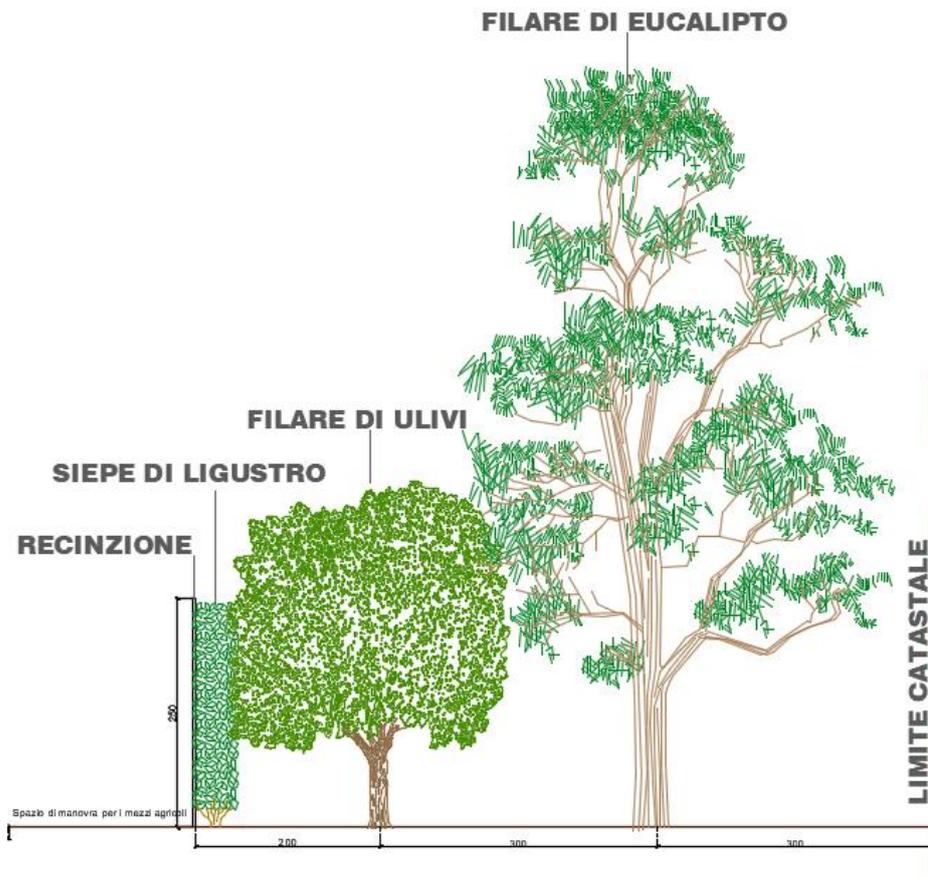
Schemi di posa delle piantumazioni delle opere di mitigazione
